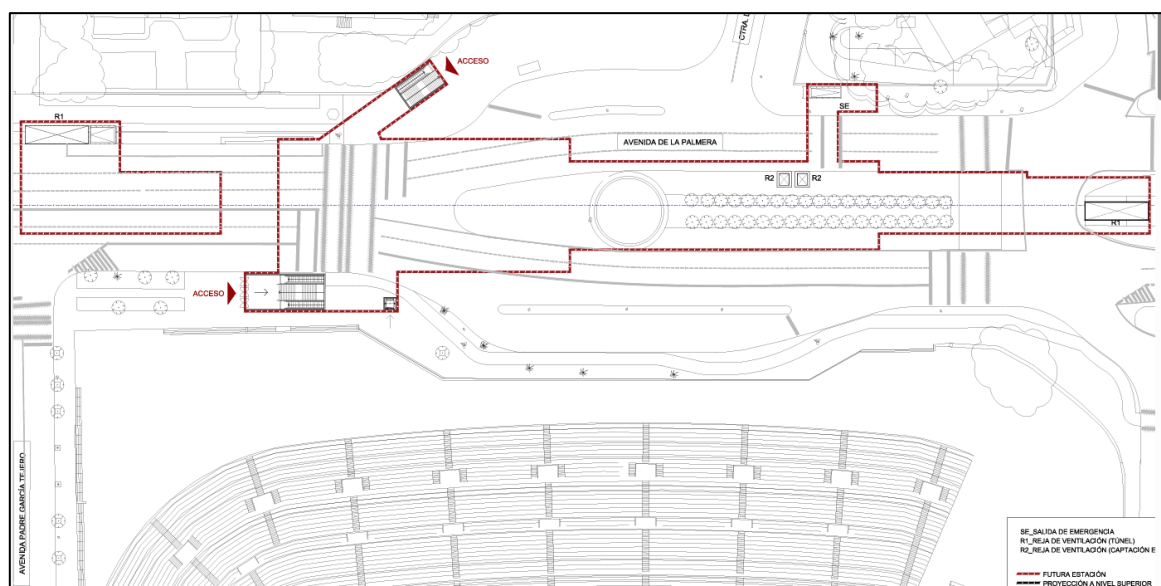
Planta de la estación de Heliópolis en la propuesta actual
